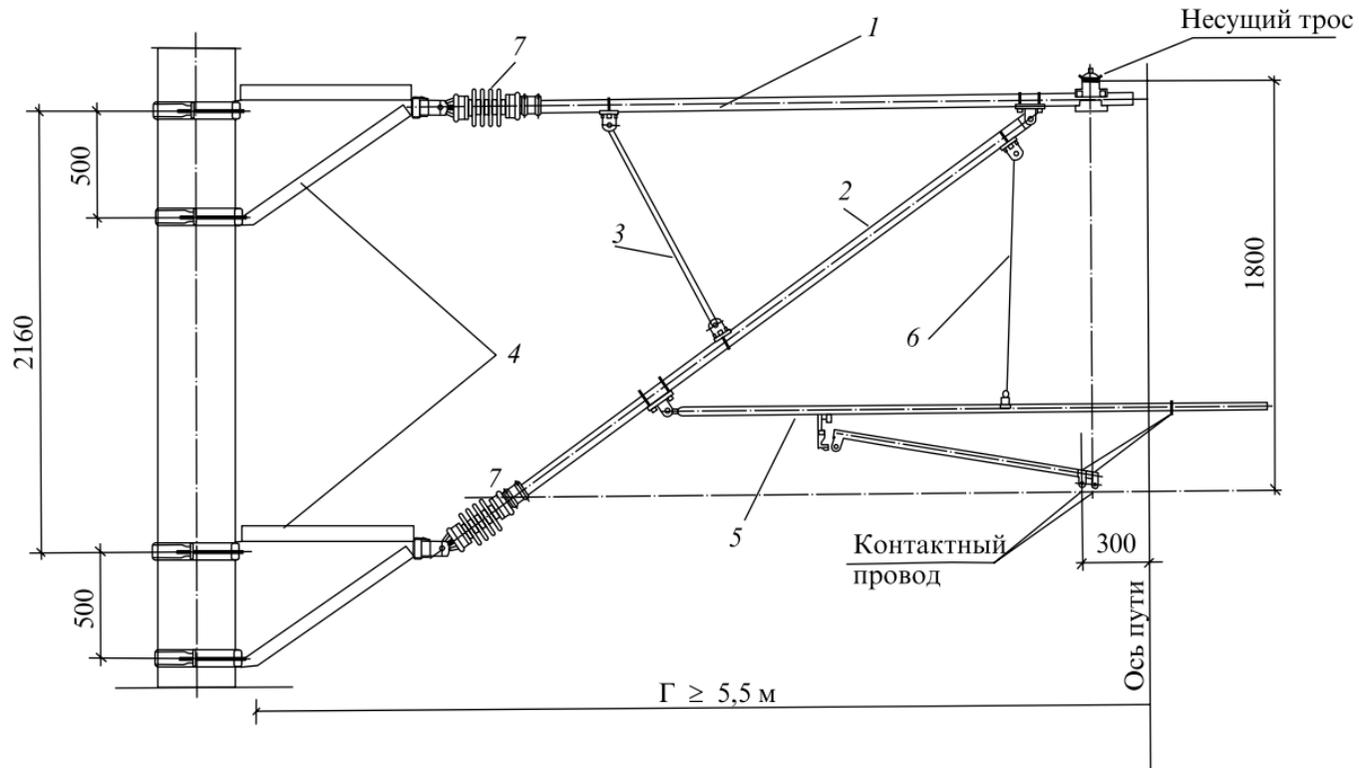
Установка изолированной консоли на столиках: 1 и 2 — горизонтальный и наклонный стержни; 3 — подкос; 4 — столик для крепления консоли; 5 — фиксатор сочлененный прямой; 6 — струна основного фиксатора; 7 — стержневой изолятор
